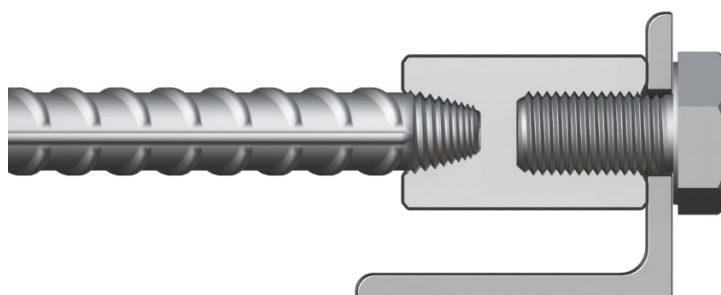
Резьбовое соединение арматуры под метрический болт
